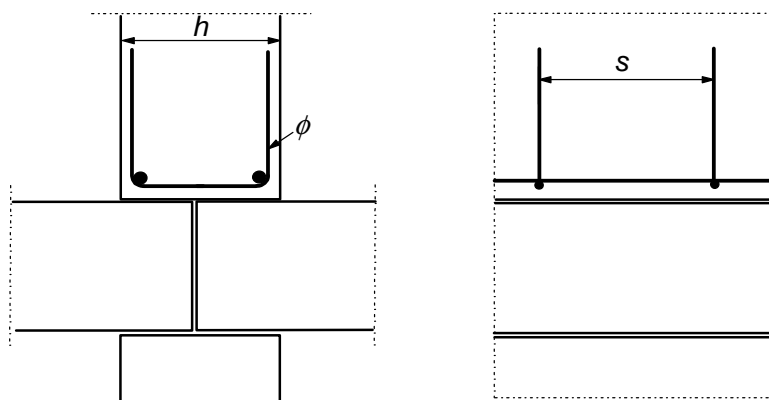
Exemplo de armaduras entre duas lajes de pavimento numa parede apoiada sobre a junta
